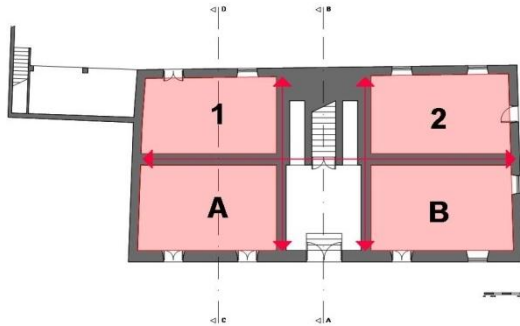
Planta do R/C- Linhas Estruturantes, Autor, 2017
